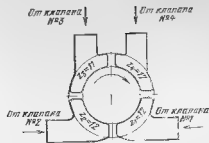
Схема сопловой коробки турбины (вид со стороны паровпуска)
